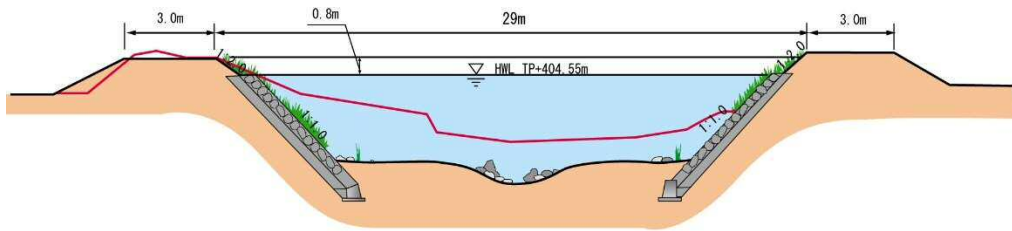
横断面图 (新庄工区, 亀尻橋付近)
